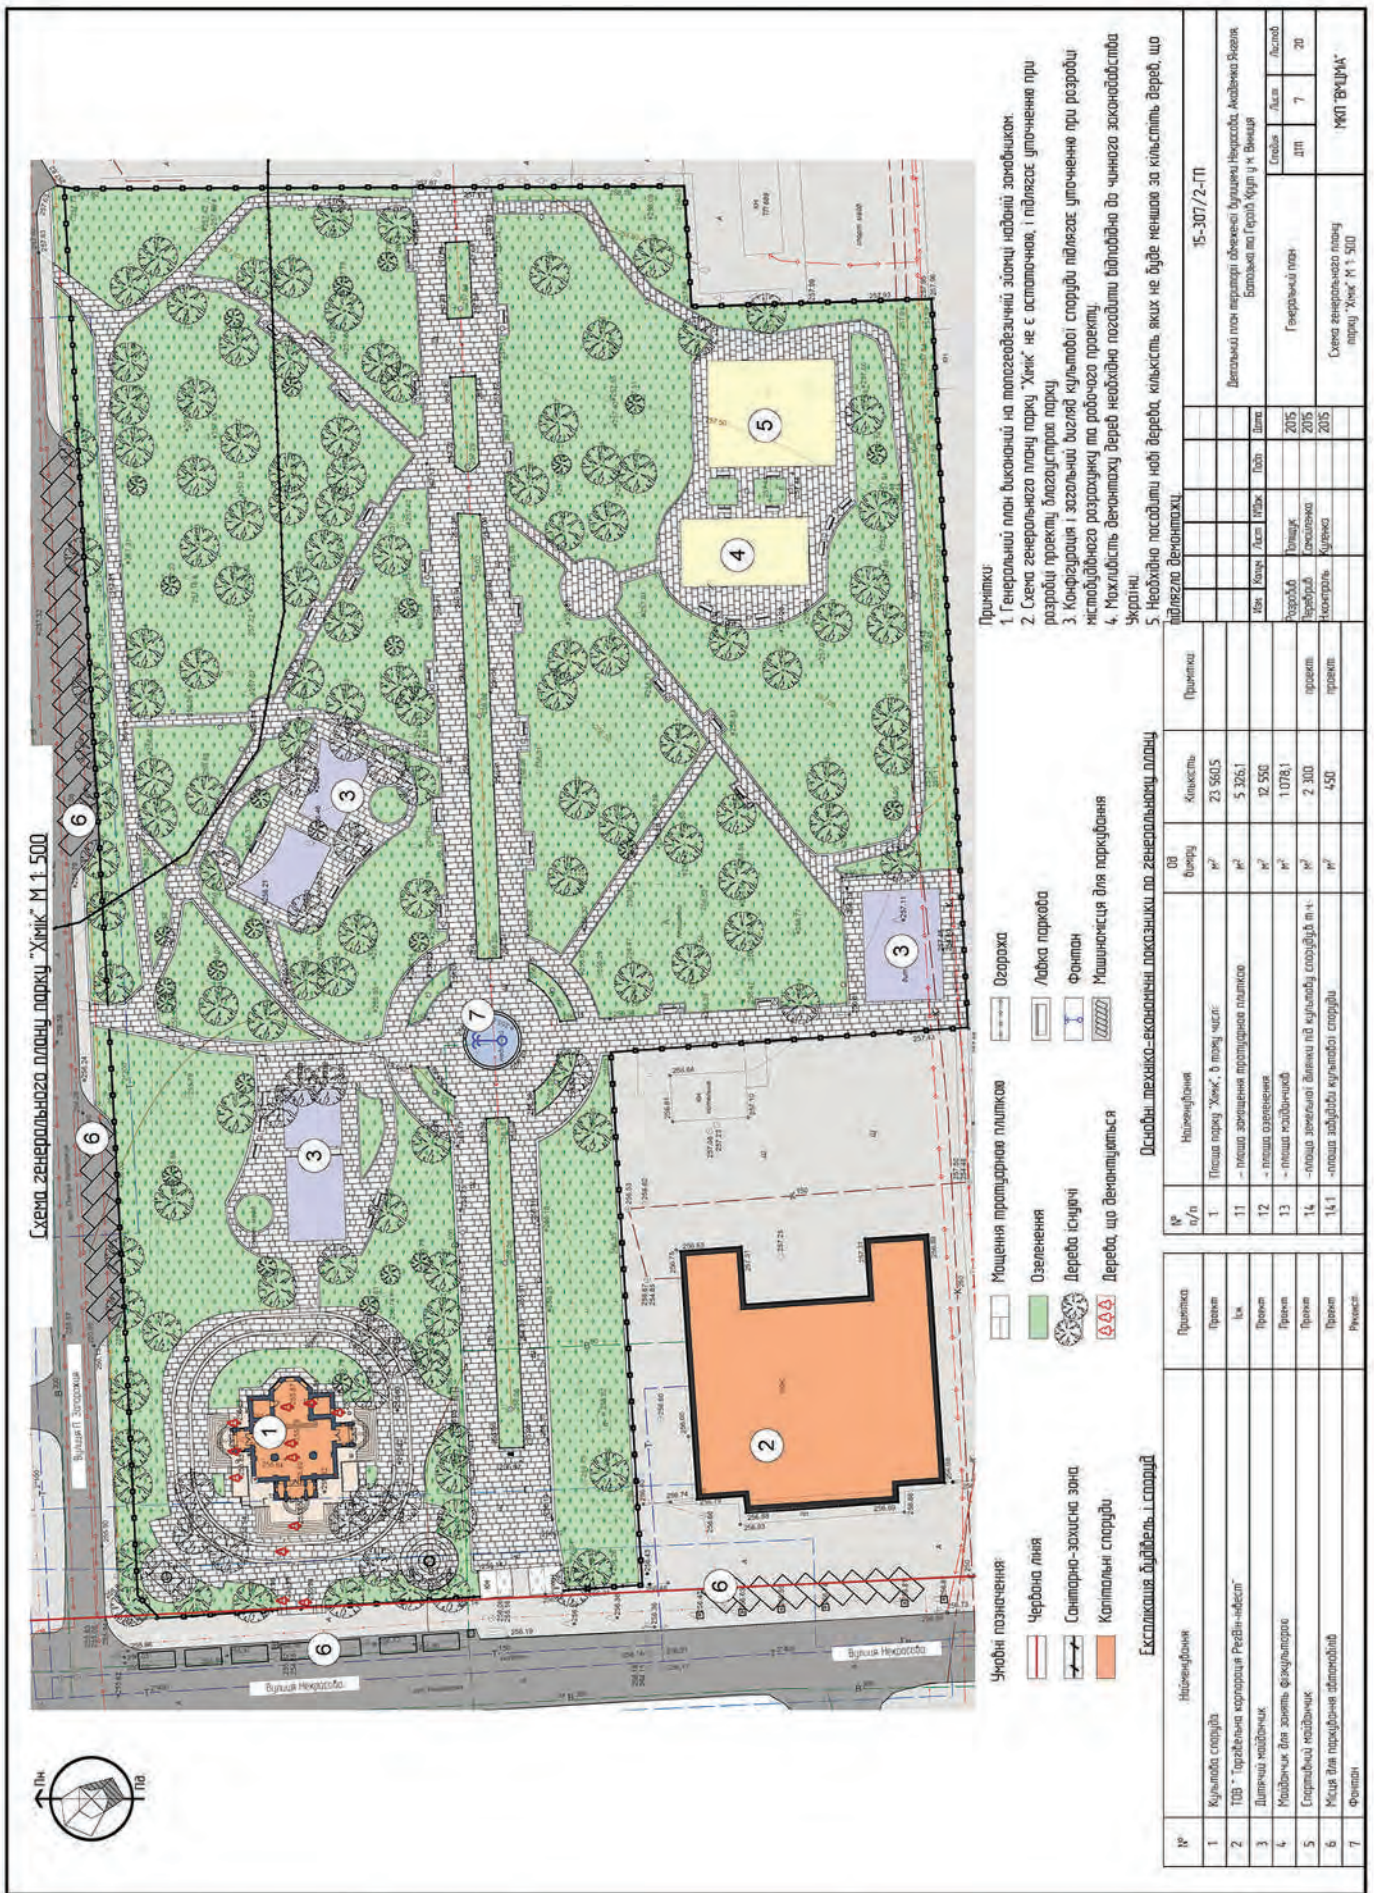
Схема генерального плану парку «Хімік», м. Вінниця
